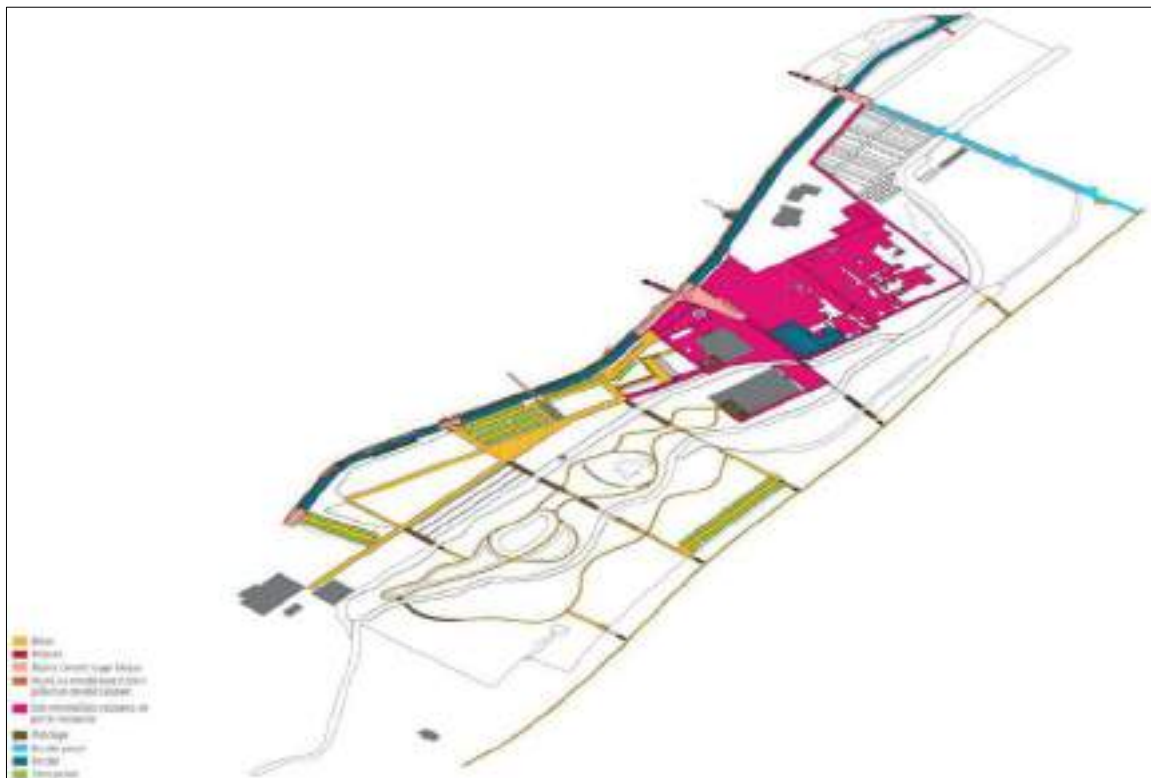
Plan de repérage des ouvrages projetés – Bâtiments /voiries/ passerelles
